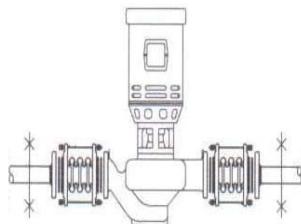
泵浦進、出口端。Pump : inlet/outlet
